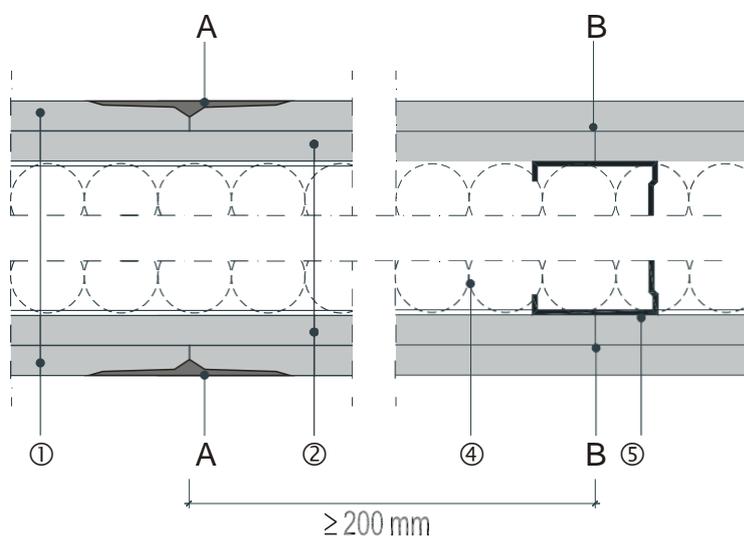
Pose d'une traverse pour traitement d'un joint horizontal (plaques BA – cloison à parement simple)
